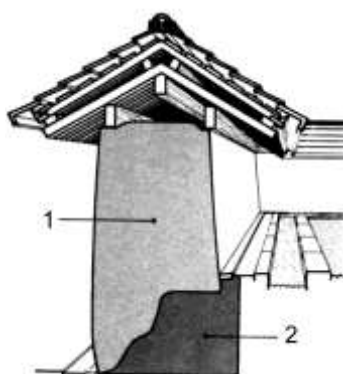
Разрез стены, ограждающей площадку сада 15-ти камней. Уровень площадки сада за время различных исторических реконструкций поднялся по отношению к наружной плоскости земли на полтора метра. 1-тело стены, 2-уровень подъема.
